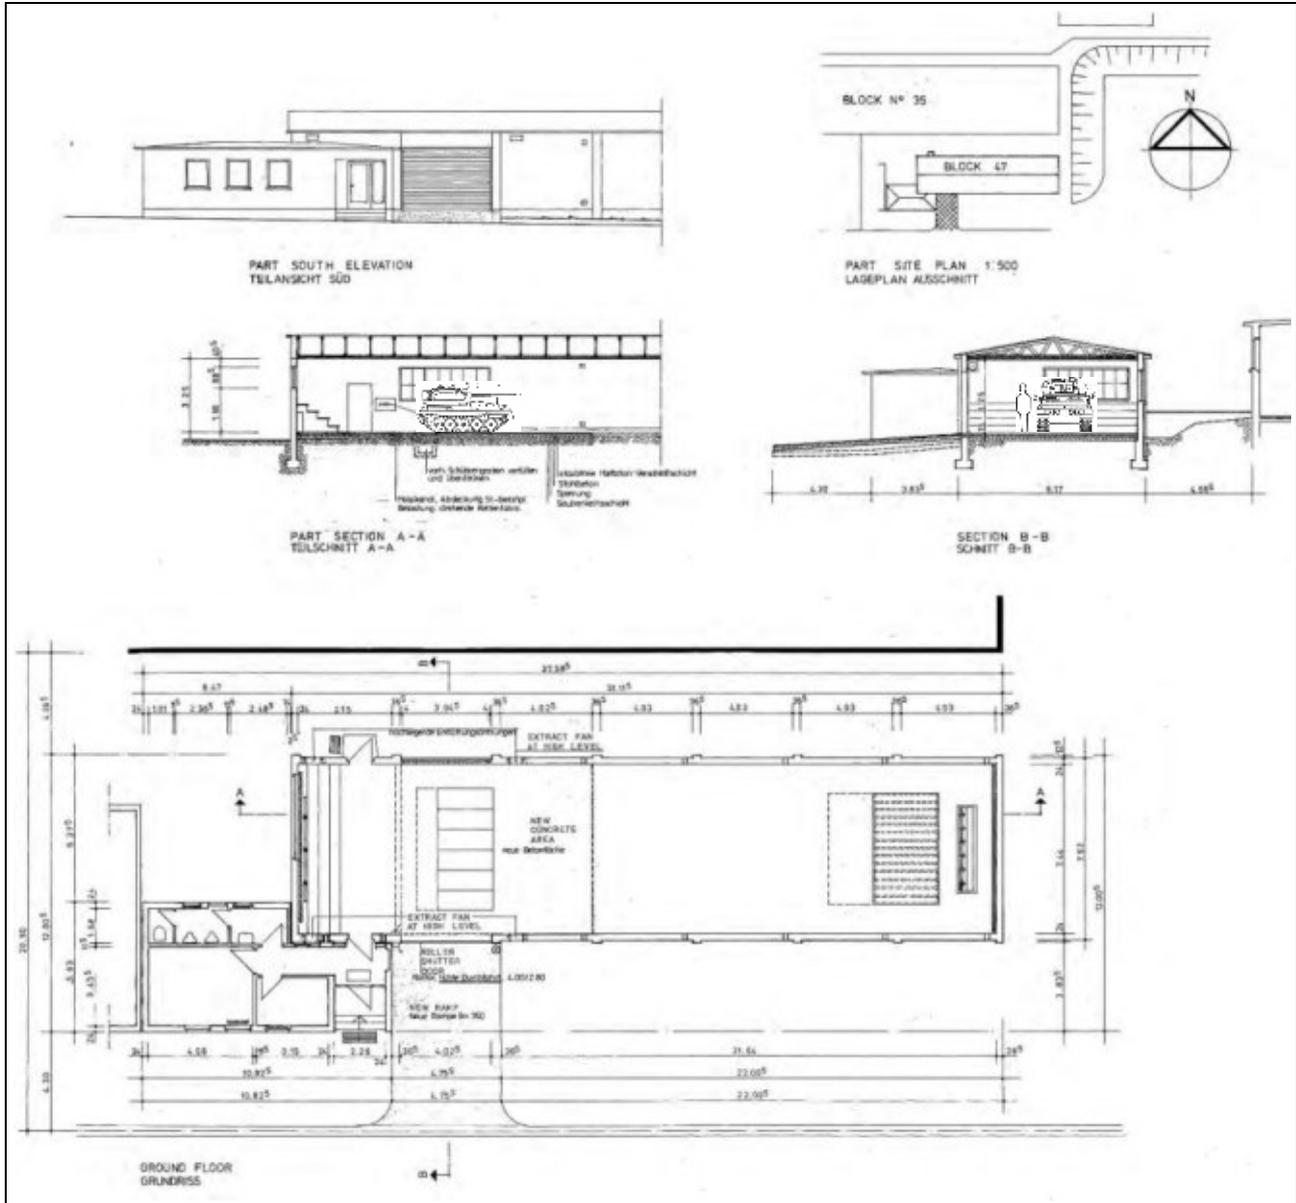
Indoor KK-Schießstand [47] (Grundriss/Schnitte) (Quelle: BIMA Münster)
